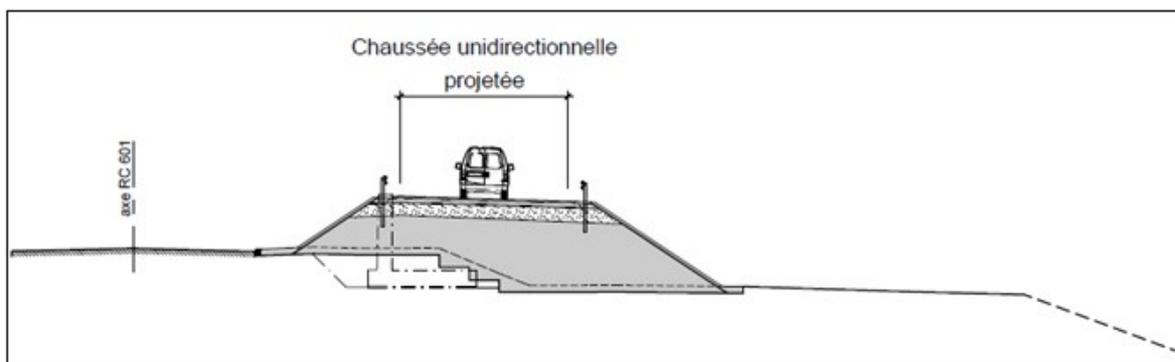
Nouvelle bretelle, profil en travers n° 2
